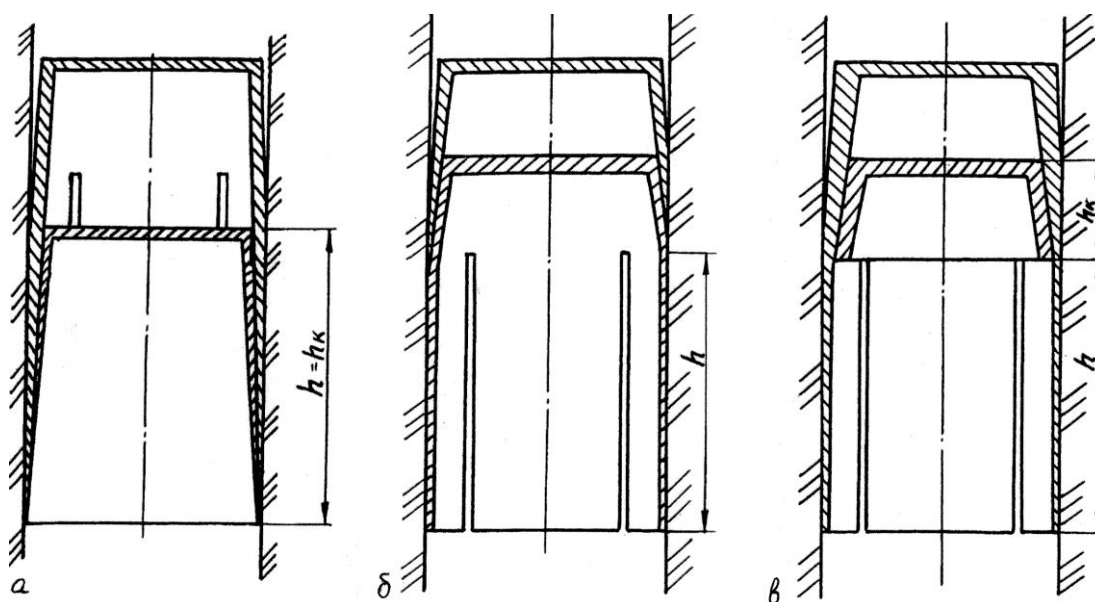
Типы забоек: *a* – распорный конус высотой $h_k = h$; *б* – укороченный разрезной цилиндр; *в* – распорный конус высотой $h_k < h$
